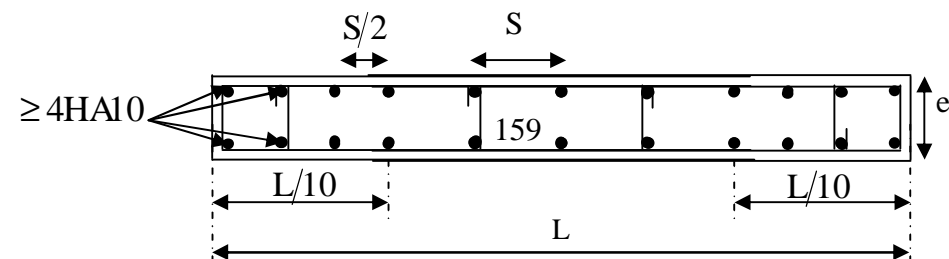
Disposition des armatures verticales dans les ..
